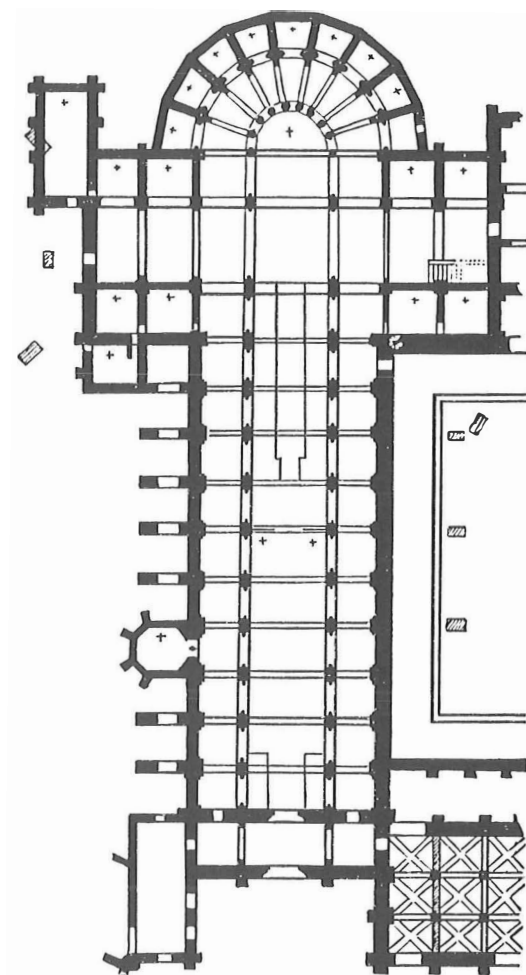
Cîteaux. Grundriss der Abteikirche II (nach A. Dimier).
